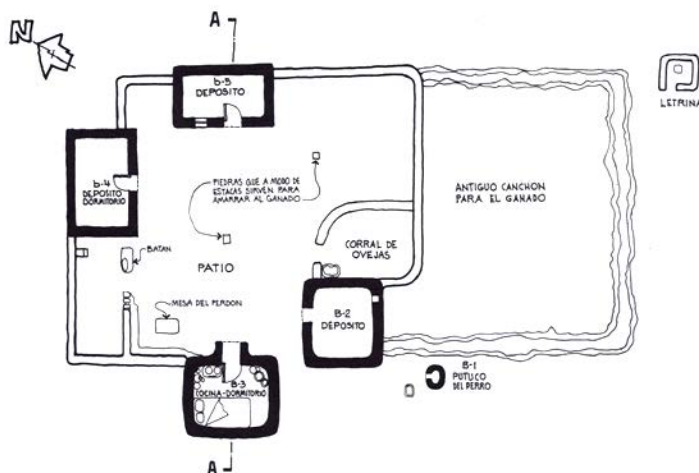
Planta típica de una vivienda de Taraco (Levantamiento desarrollado a la vivienda del señor Paulo Chambi, por el Arq. Ferruccio Marussi Castellan, 1999)
